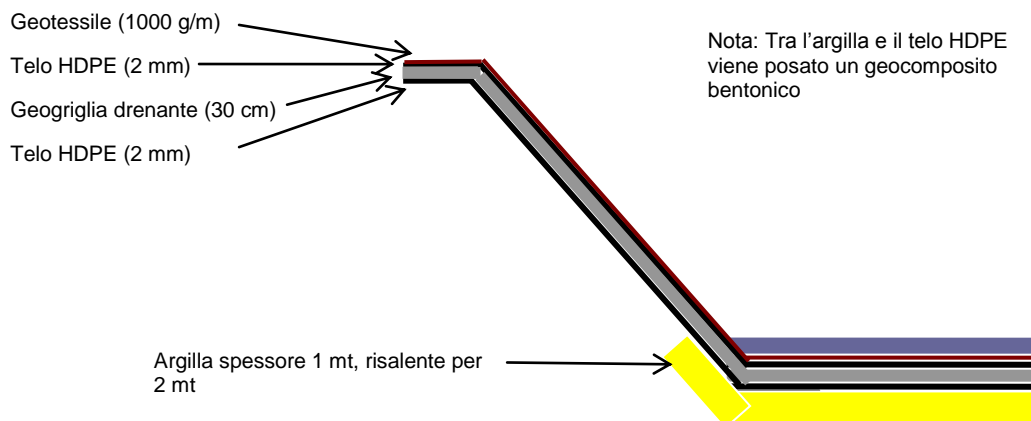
Sezione della discarica lotto C. Sistema di impermeabilizzazione sponde laterali.
